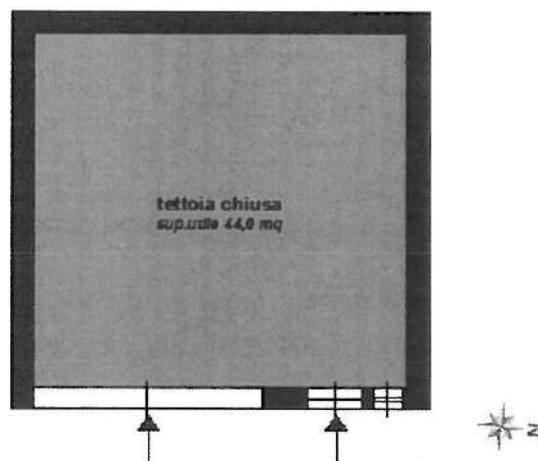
PIANTA LOCALE TETTOIA-STATO ATTUALE
